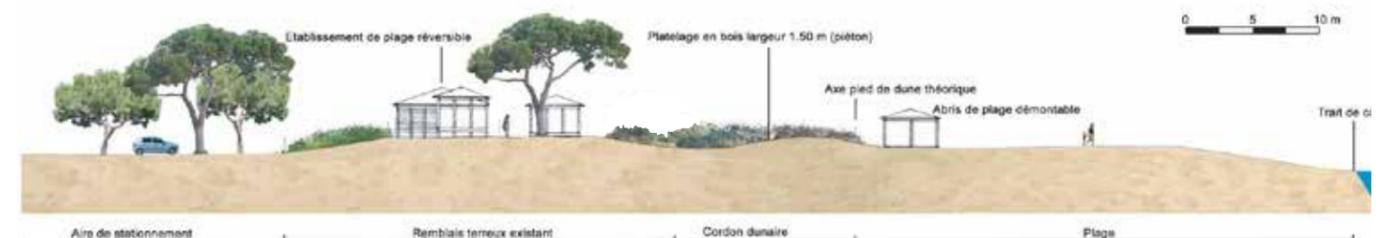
Coupe de principe sur les établissements de plage réversibles
